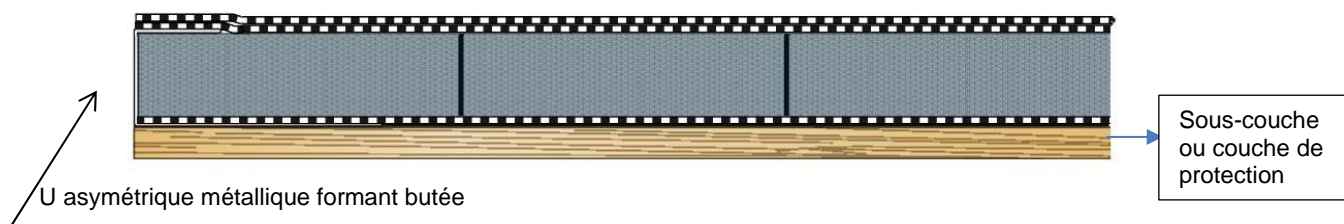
Coupe de principe sur rive sans acrotère, sur élément porteur bois - panneaux à base de bois, sous-couche ou couche de protection sur panneau bois.
